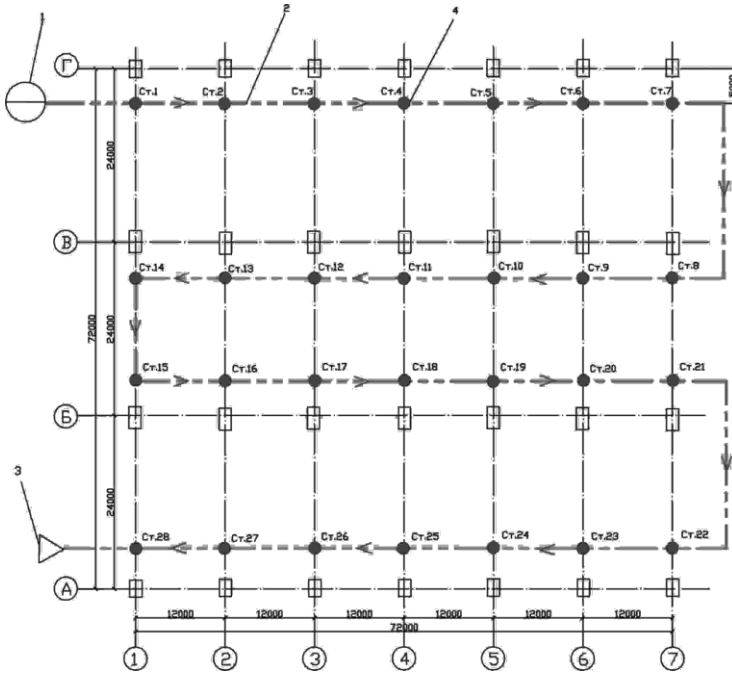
Технологічна схема монтажу проектуємої будівлі: 1 – початок руху крана; 2 – напрям руху крана; 3 – кінець руху крана ; 4 – стоянка крану для монтажу колон.
